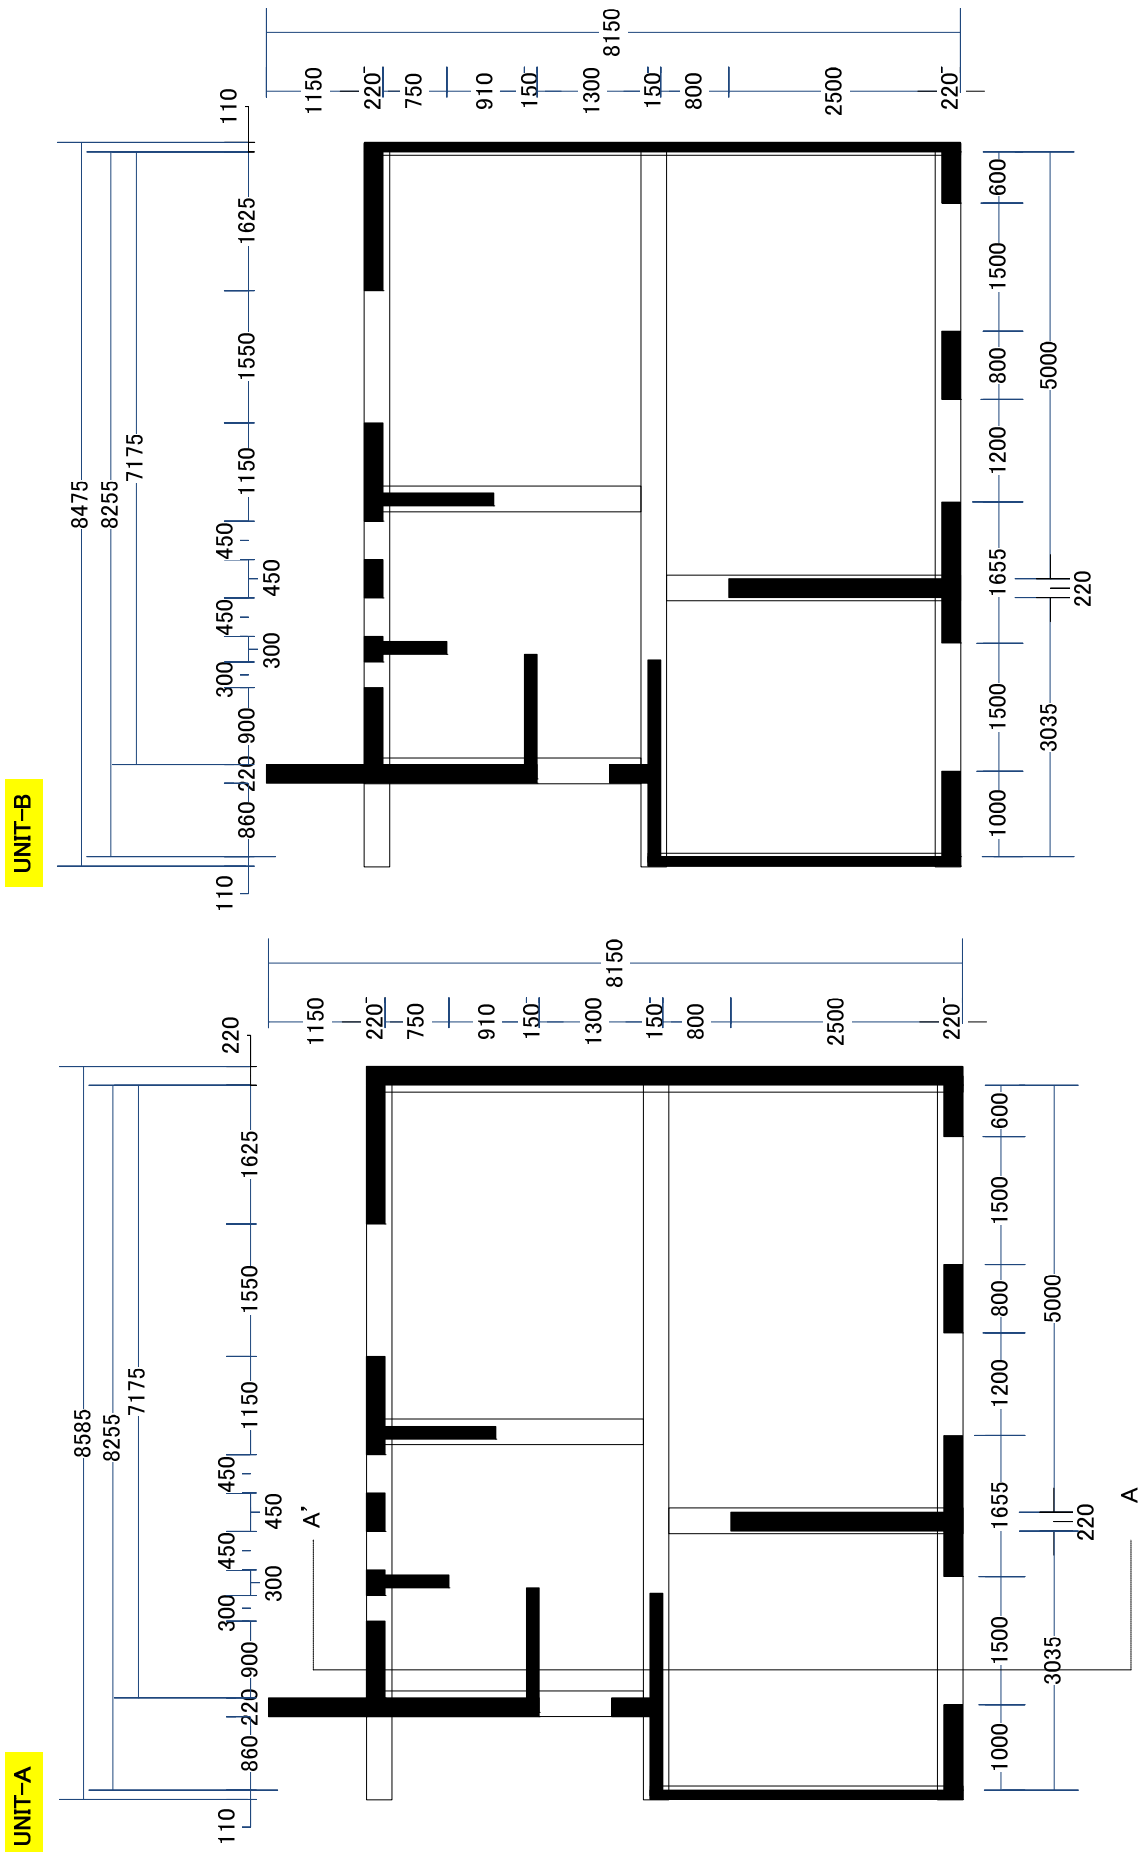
雇用促進住宅陸前高田第2 宿舎の平面図 (単位 : mm)
